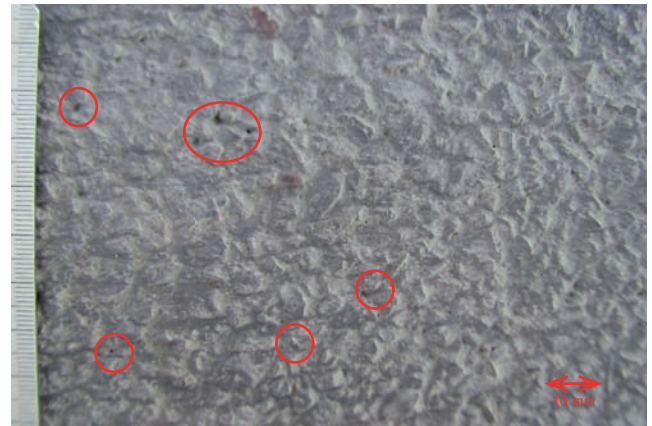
Makroaufnahme einer Waschbetonoberfläche mit CEM III/A-Zement
